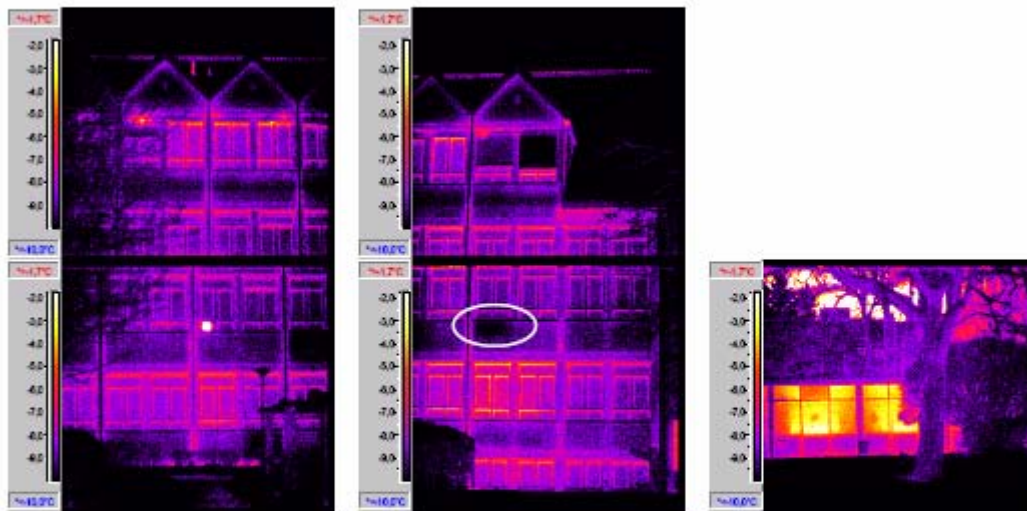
Fachtrakt mit Glasverbindungsgang zum Hauptgebäude
